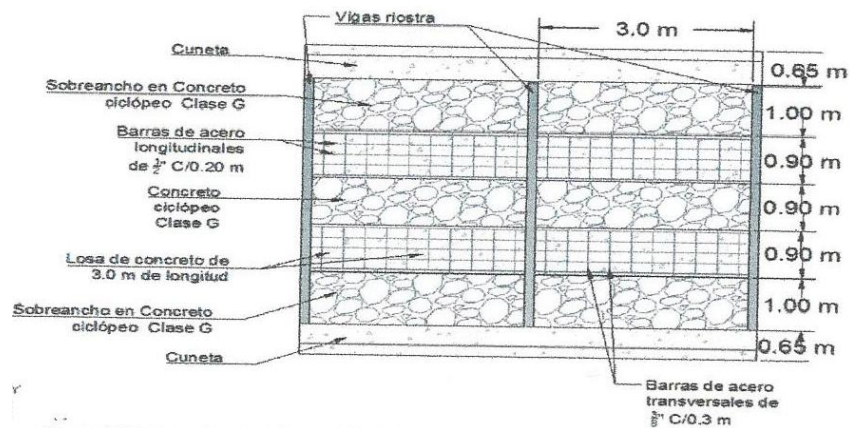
Vista en planta de la modulación propuesta para la placa huella del proyecto
